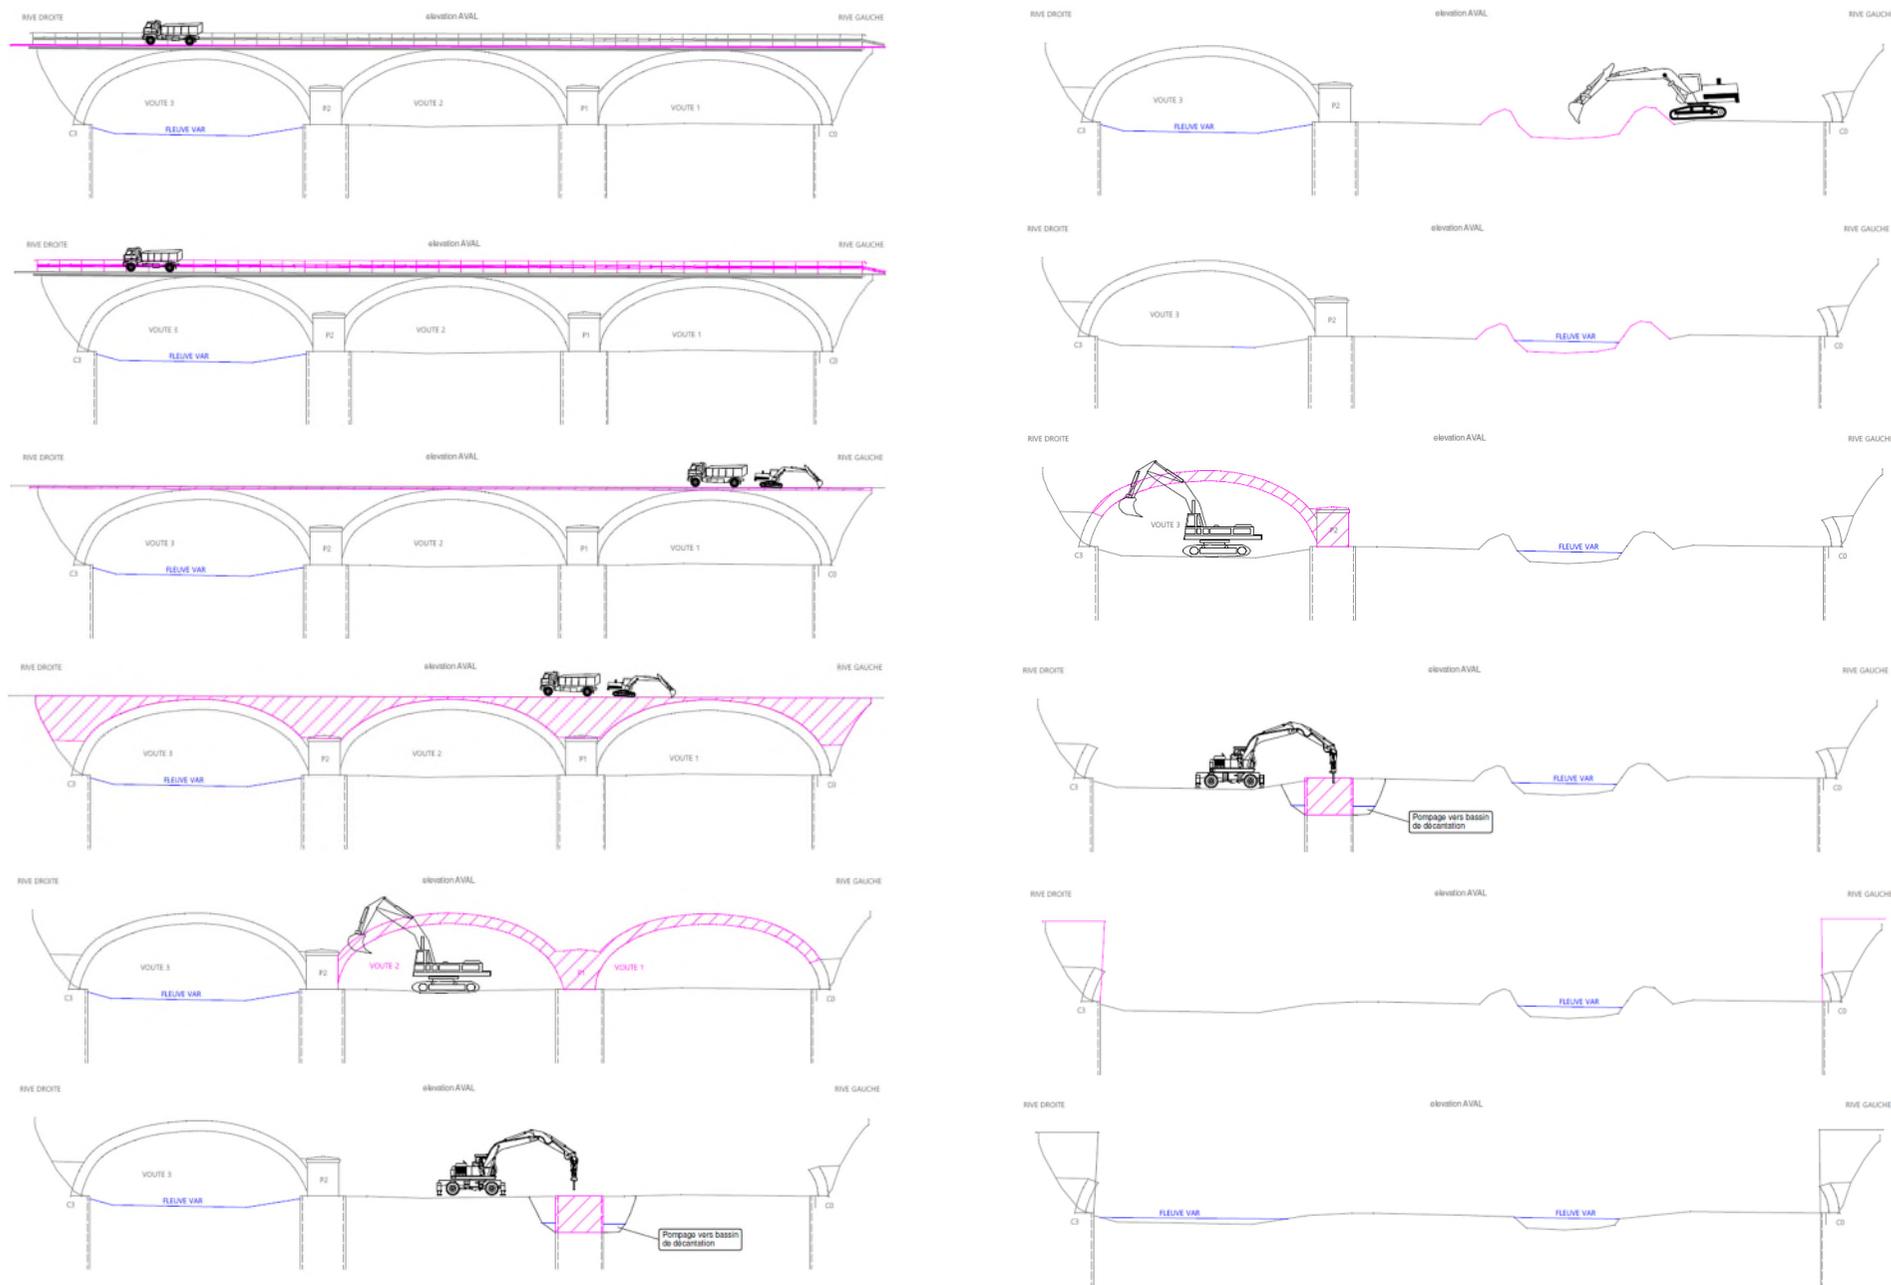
phasage de la déconstruction de l'ouvrage existant
